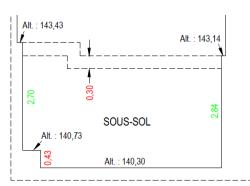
Coupe spécifique (extrait) — Planchers de type privatif — Hauteurs facultatives
